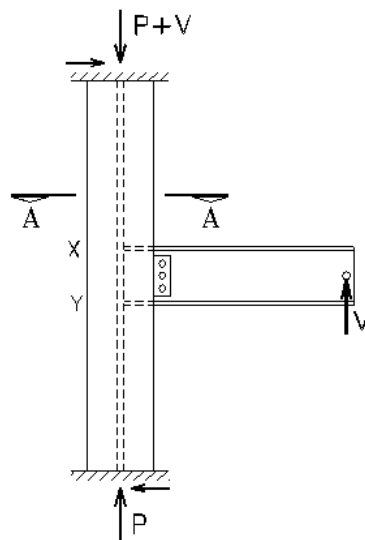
Ligação viga-coluna através da alma do pilar
